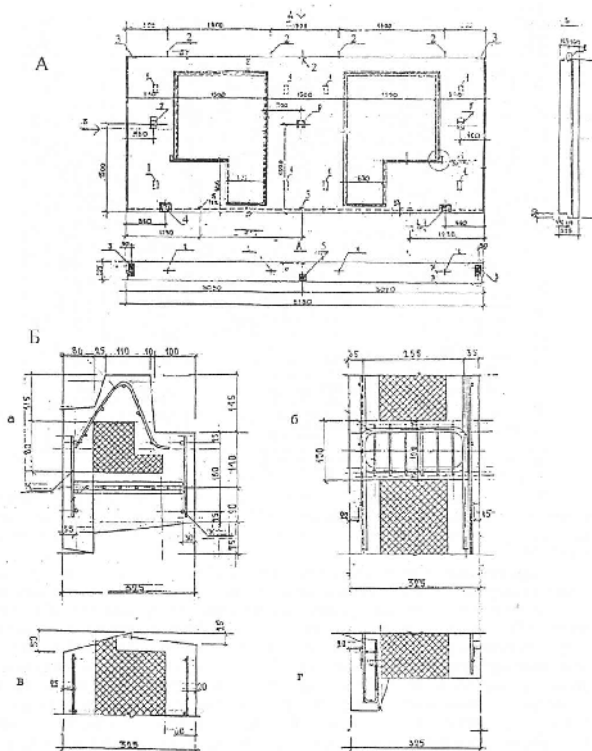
Трехслойная бетонная панель с бетонными шпунцовыми связями между слоями: А – схема армирования; 1 – бетонная шпонка; 2 – подъемная петля; 3 и 4 – закладные детали; 5 – петлевой выпуск; Б – детали сечений трехслойной панели со шпунцовыми связями: а – армирование стыкового гребня; б – то же, соединительные шпонки; в – подоконных зон; г – надоконных зон
